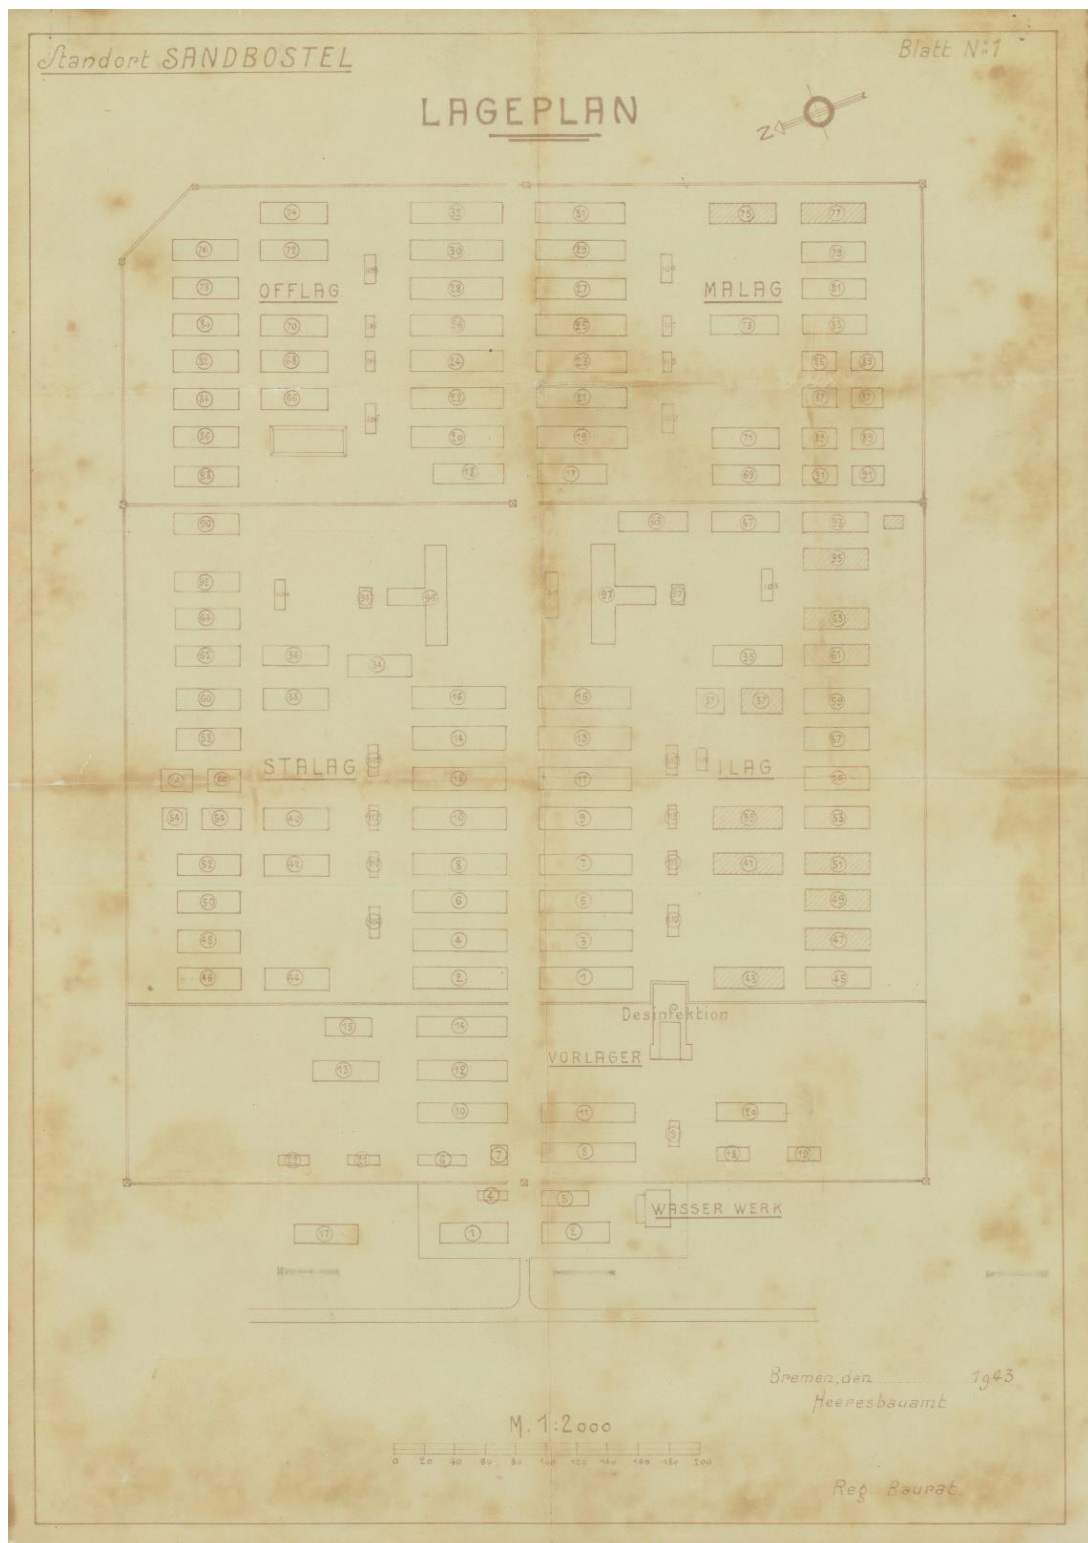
Plan: Heeresbauamt Bremen, 1943. Privatbesitz
